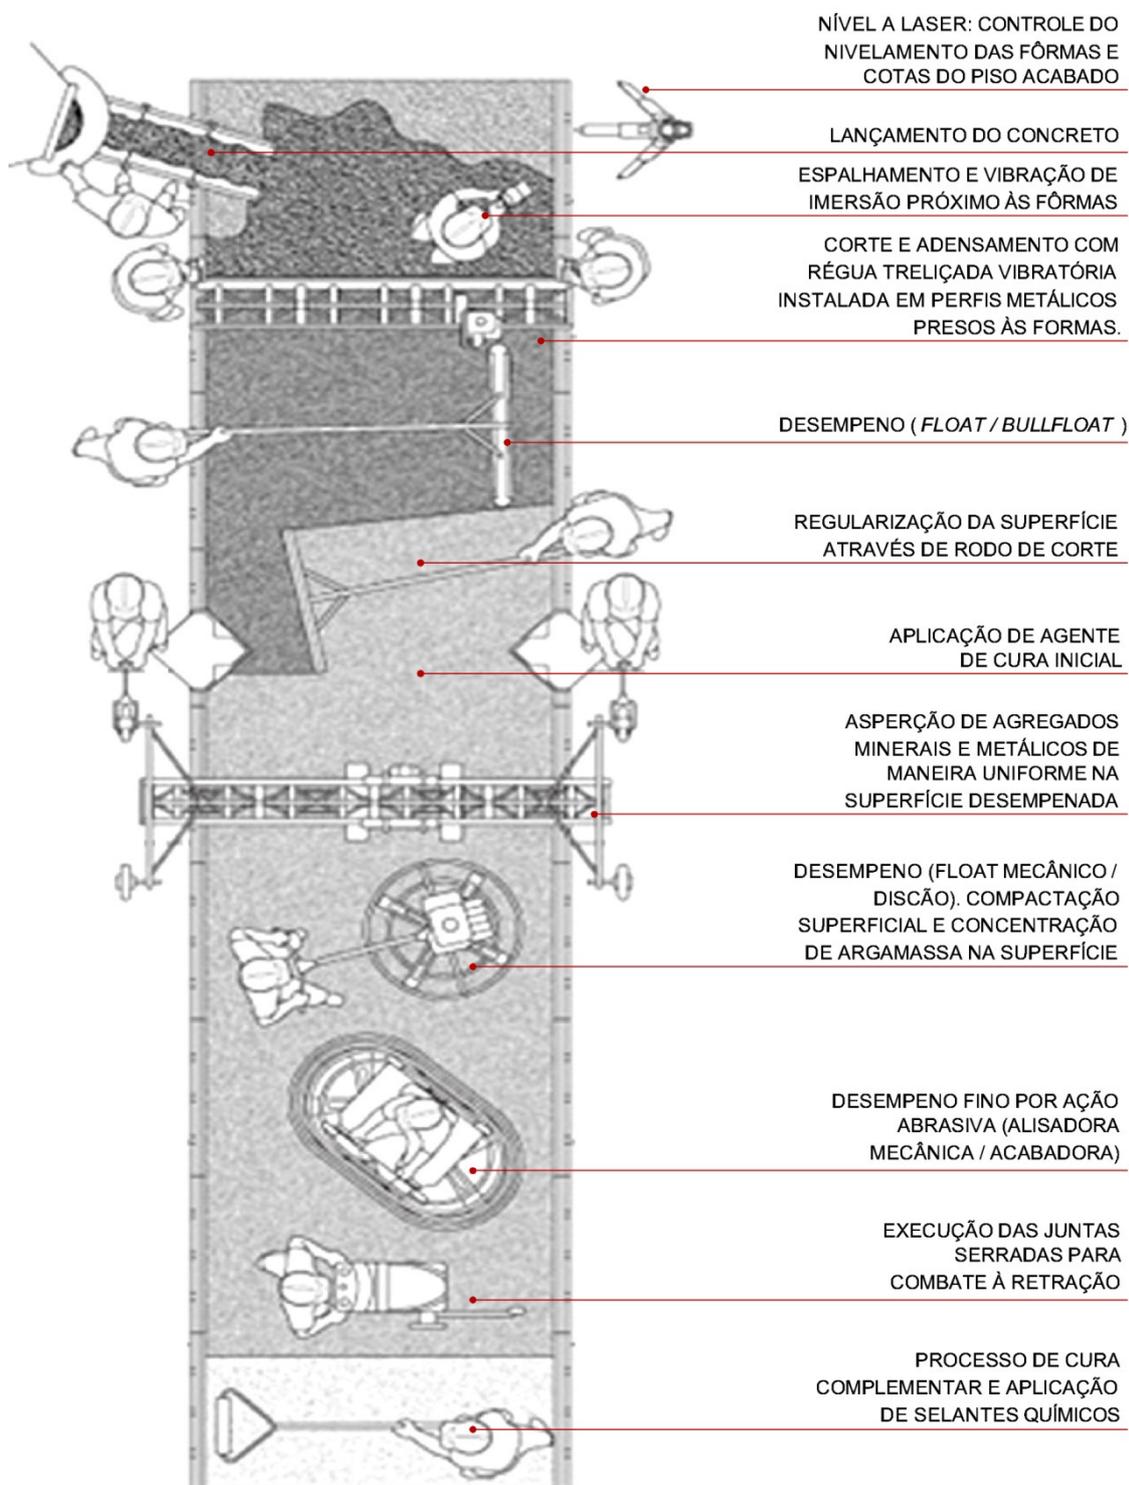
Processo executivo da concretagem de pavimentos industriais
